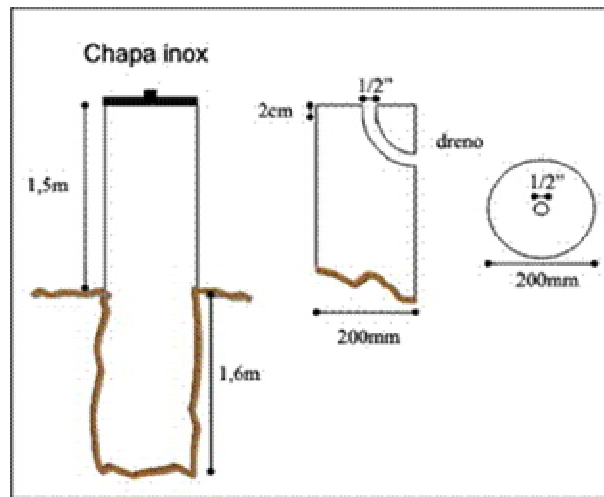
Detalhe mostrando o dispositivo de centragem forçada afixado na extremidade do pilar de concreto.
